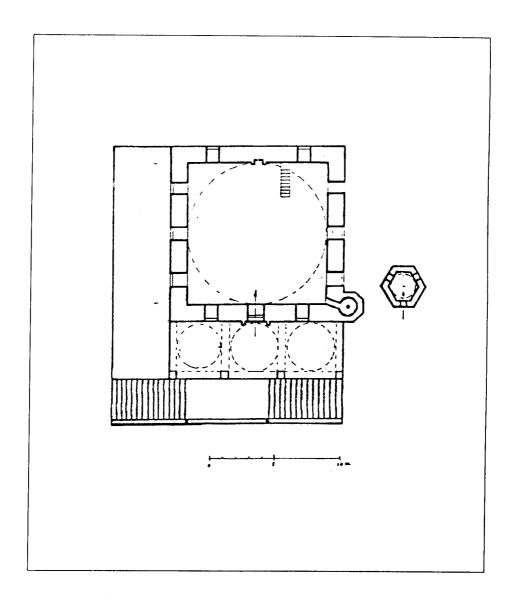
مسقط أفقي لمسجد قيرشنلو في بيرات (عن : كيل) .
